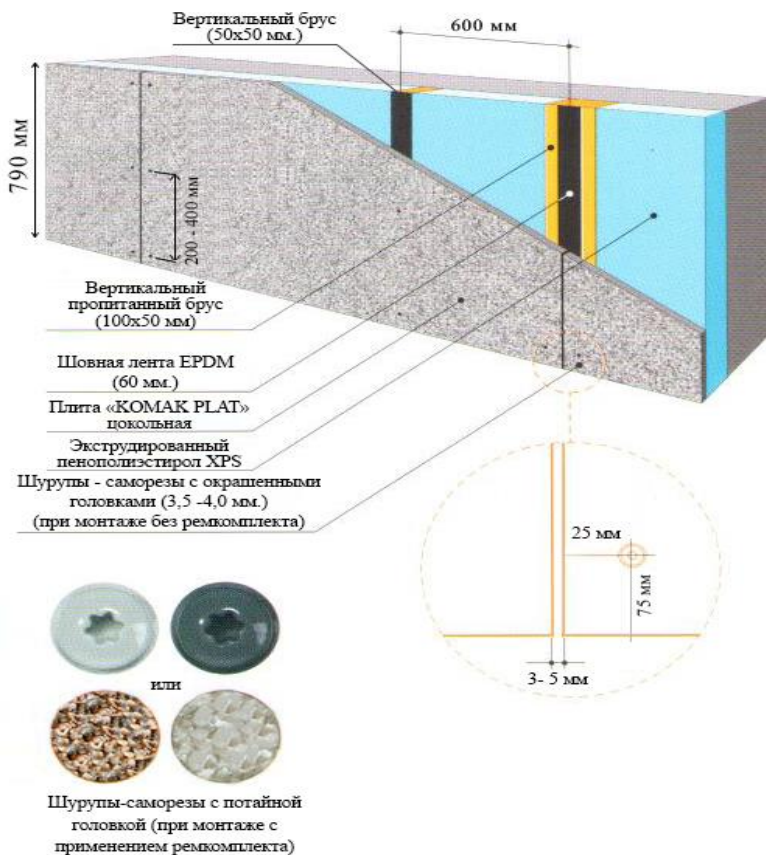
Схема монтажа цокольной плиты КОМАК PLAT на бетонное основание с применением шурупов.
